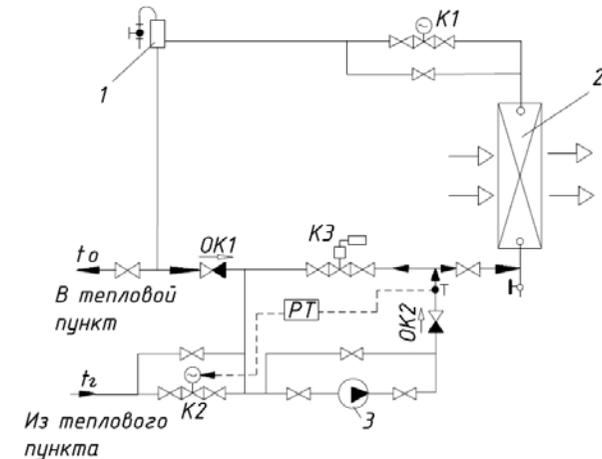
принципиальная схема смесительной установки теплоснабжения воздухонагревателей второго подогрева: 1 - воздухообменник; 2 - воздухонагреватель второго подогрева; 3 – насос.,
